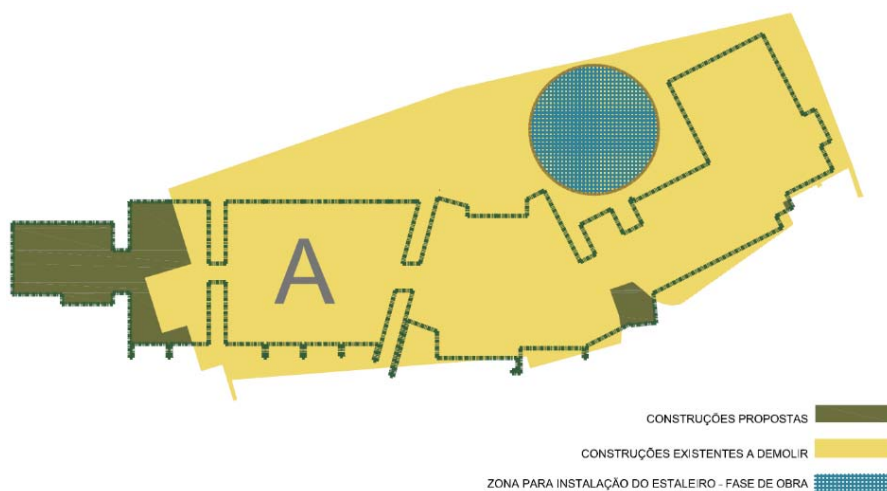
Indicação da área proposta para a instalação do estaleiro.
